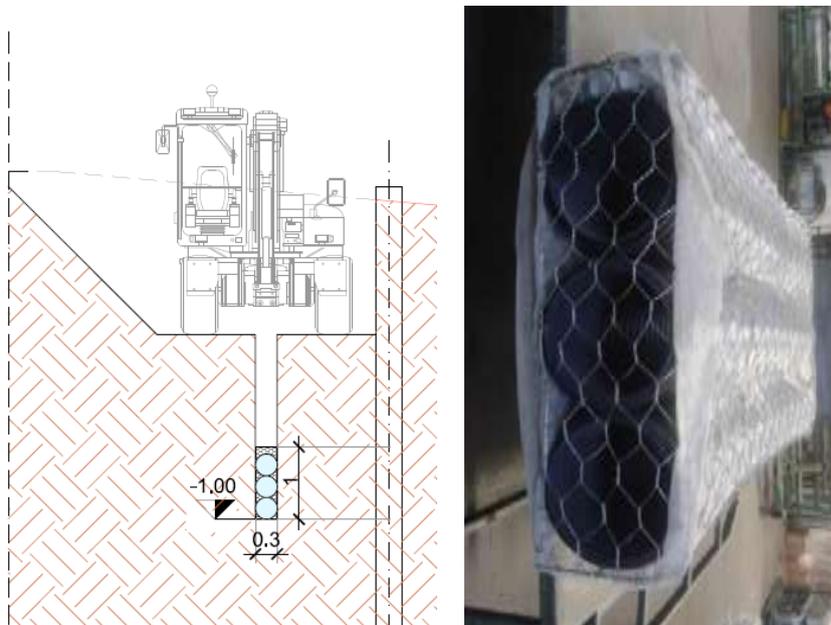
prescavo a sezione aperta e scavo in sezione ristretta della trincea a tergo del diaframma, posa del pannello prefabbricato con tubi micro fessurati
